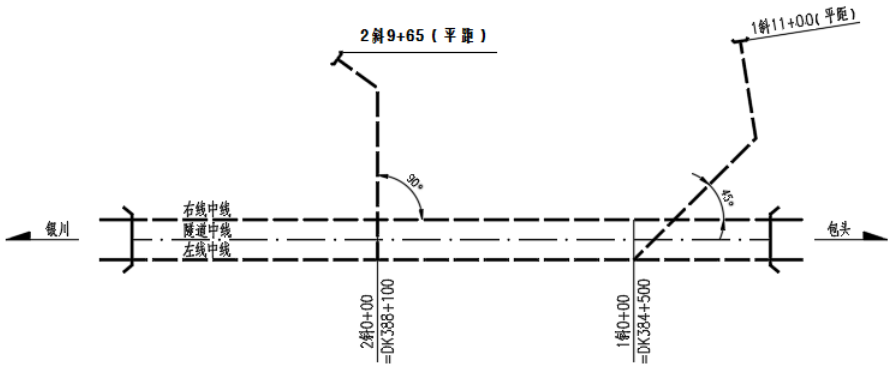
甘德尔山隧道斜井布置平面示意图
